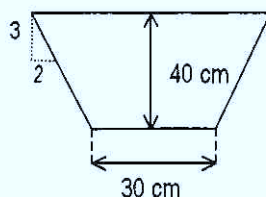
Sezione di progetto del canale di drenaggio n.2.
